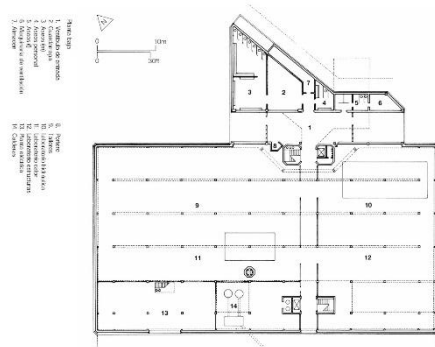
LEICESTER UNIVERSITY ENGINEERING BUILDING PLANTA. FUENTE: :
